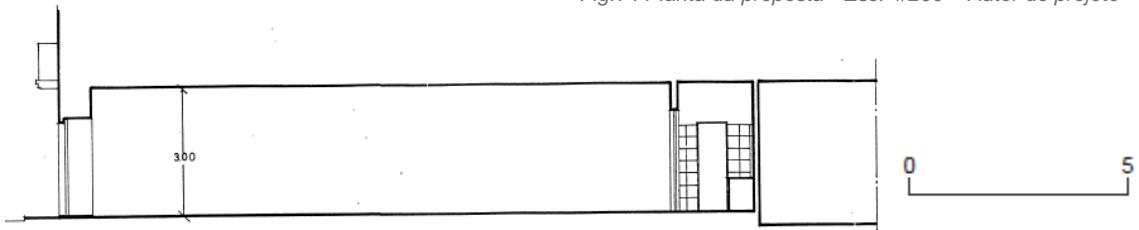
Corte AB - Esc. 1/200 – Autor do projeto
